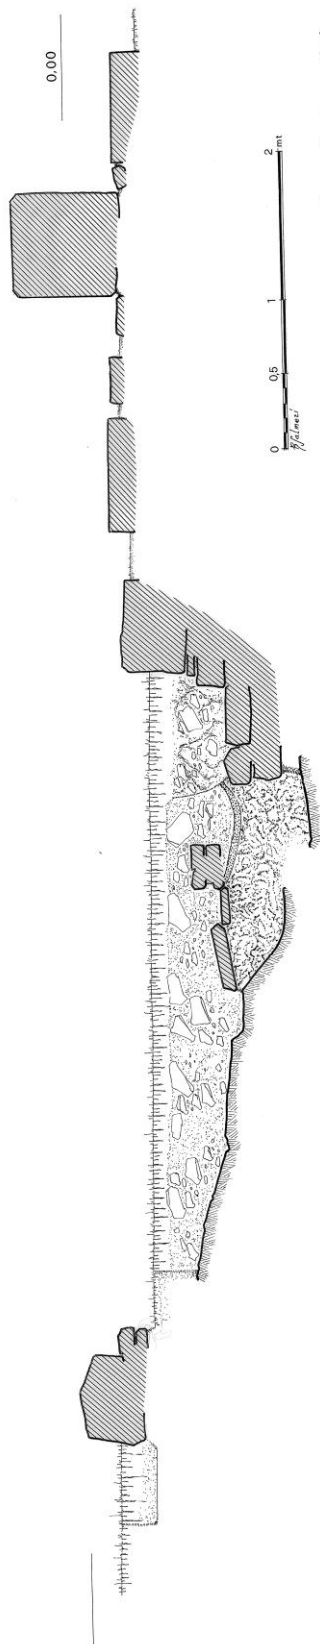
Area del Bastione - Sezione I-I'
